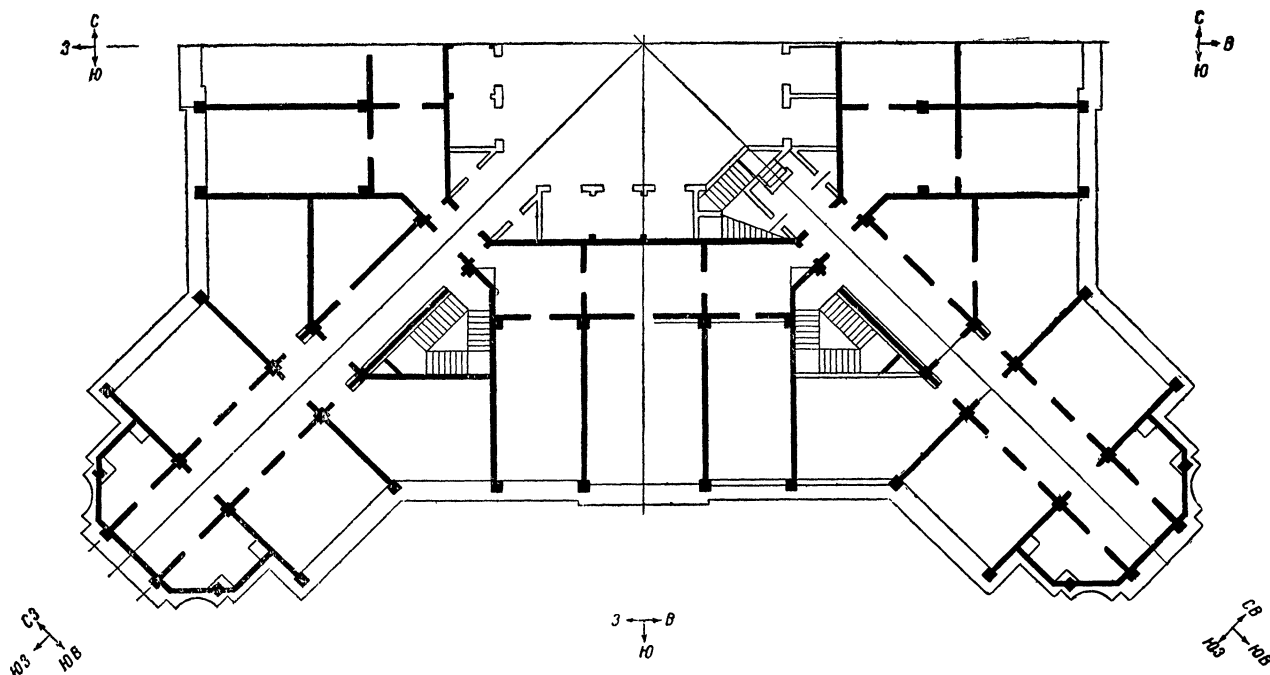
План железобетонного ростверка на 32-м (техническом) этаже
